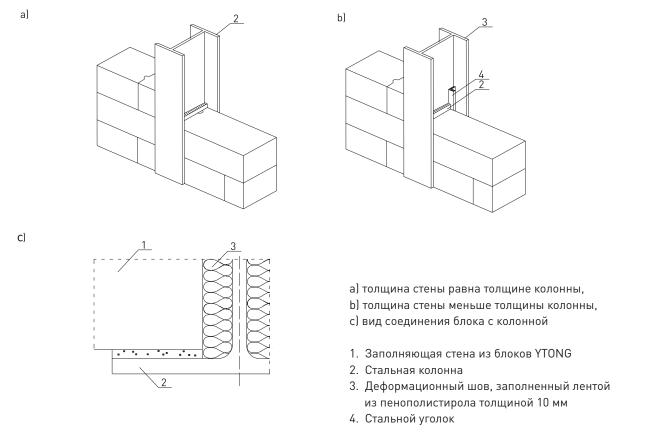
Соединение заполняющей стены из блоков YTONG со стальной колонной
